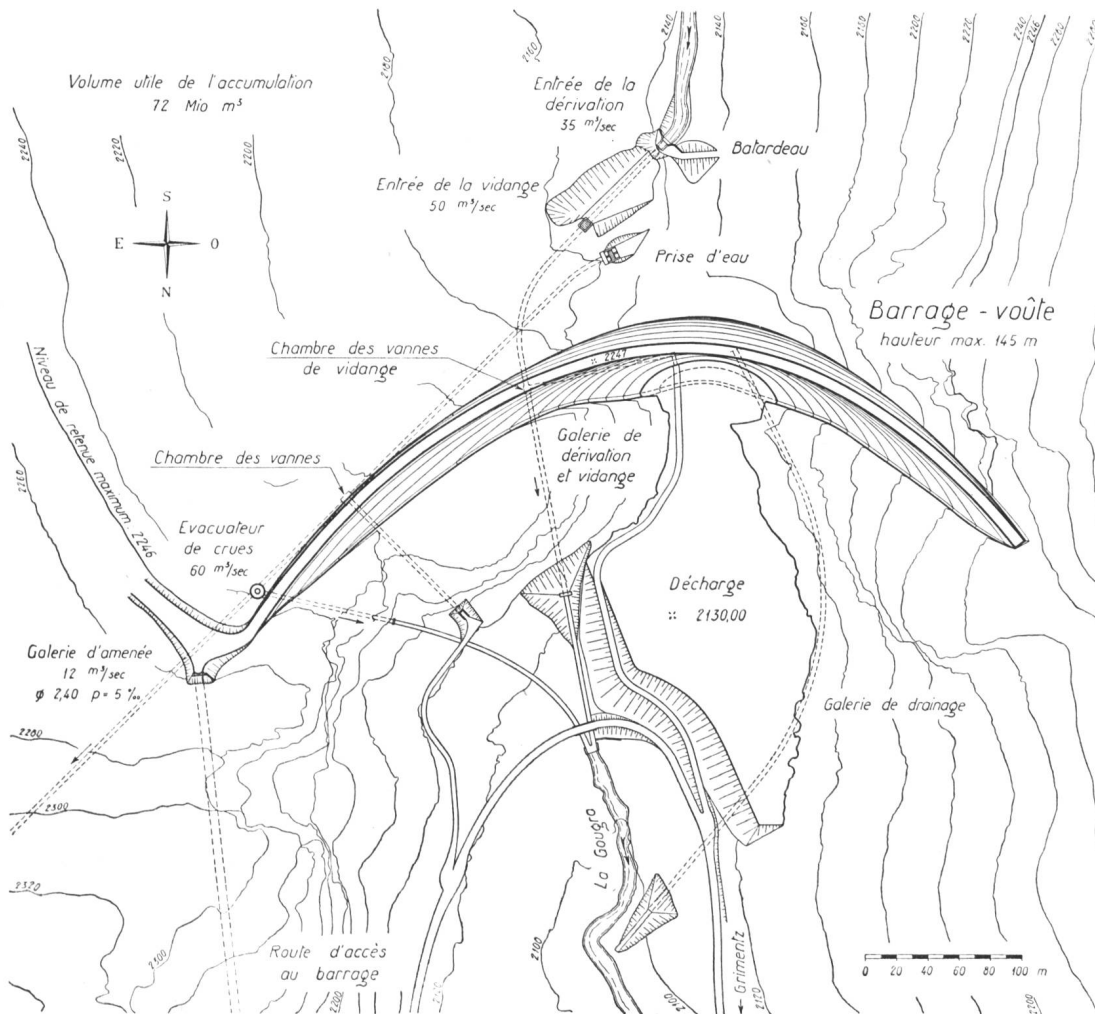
Staumauer Moiry, Lageplan 1: 5000
